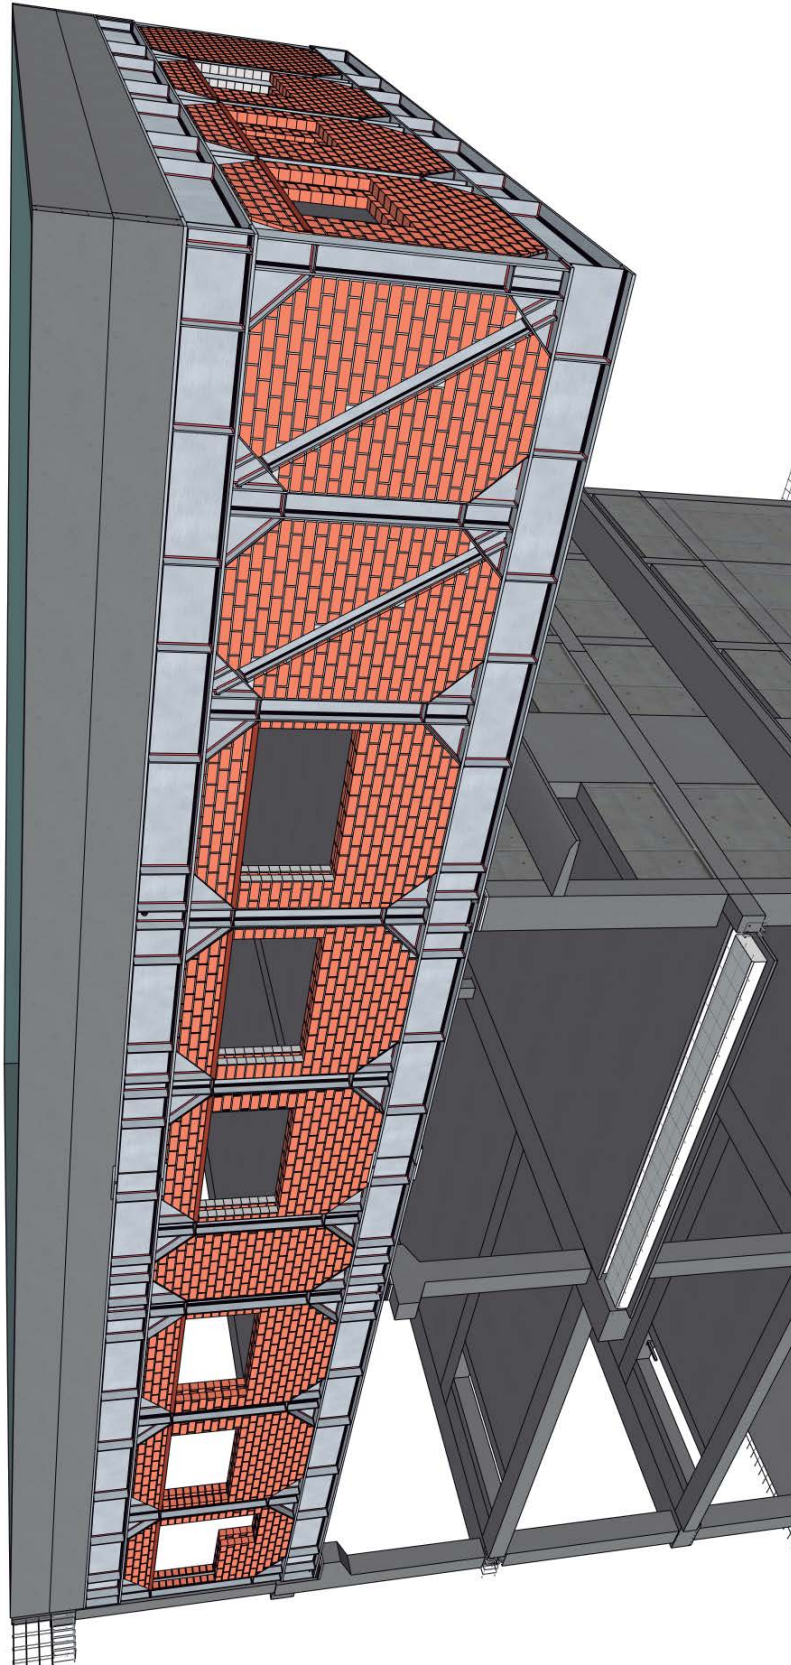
Cierre exterior de la estructura metálica del voladizo
